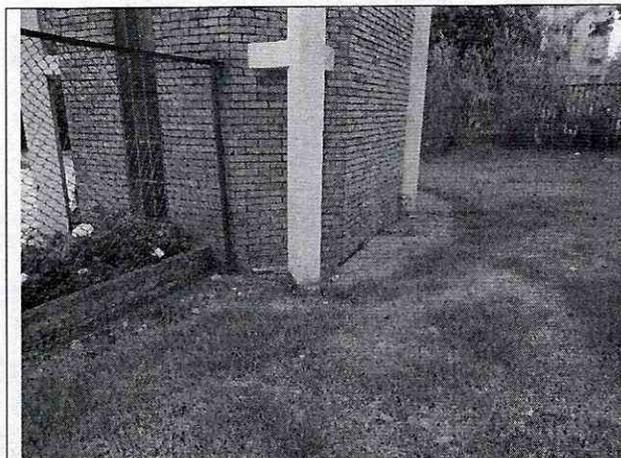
y 4: Estado de la columnas exteriores de la torre
